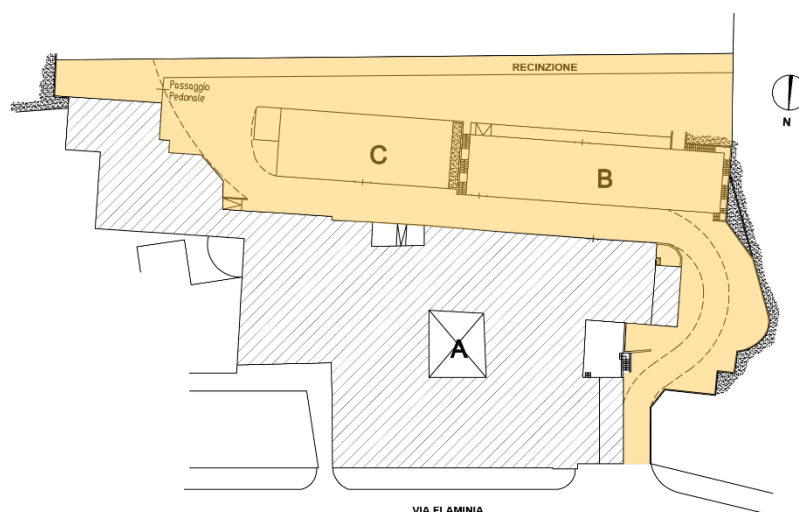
Quadro d'unione dell'area di progetto
